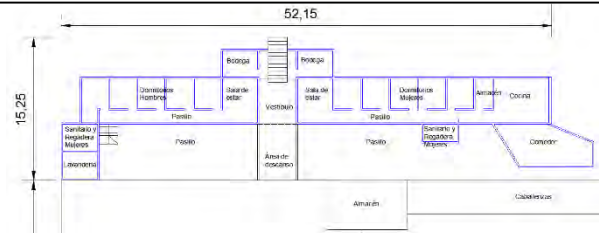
Croquis de planta alta de la Clínica Siete Ángeles, realizado por HGMB.
